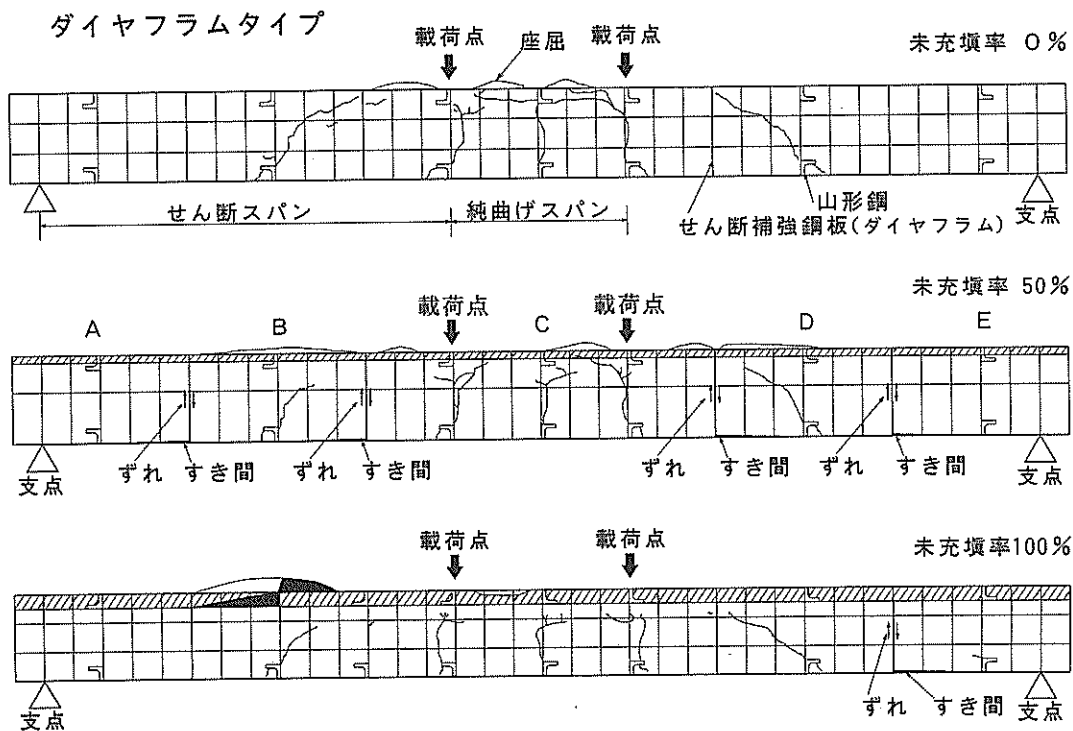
ダイヤフラムタイプの曲げ試験体でのひび割れの状況
